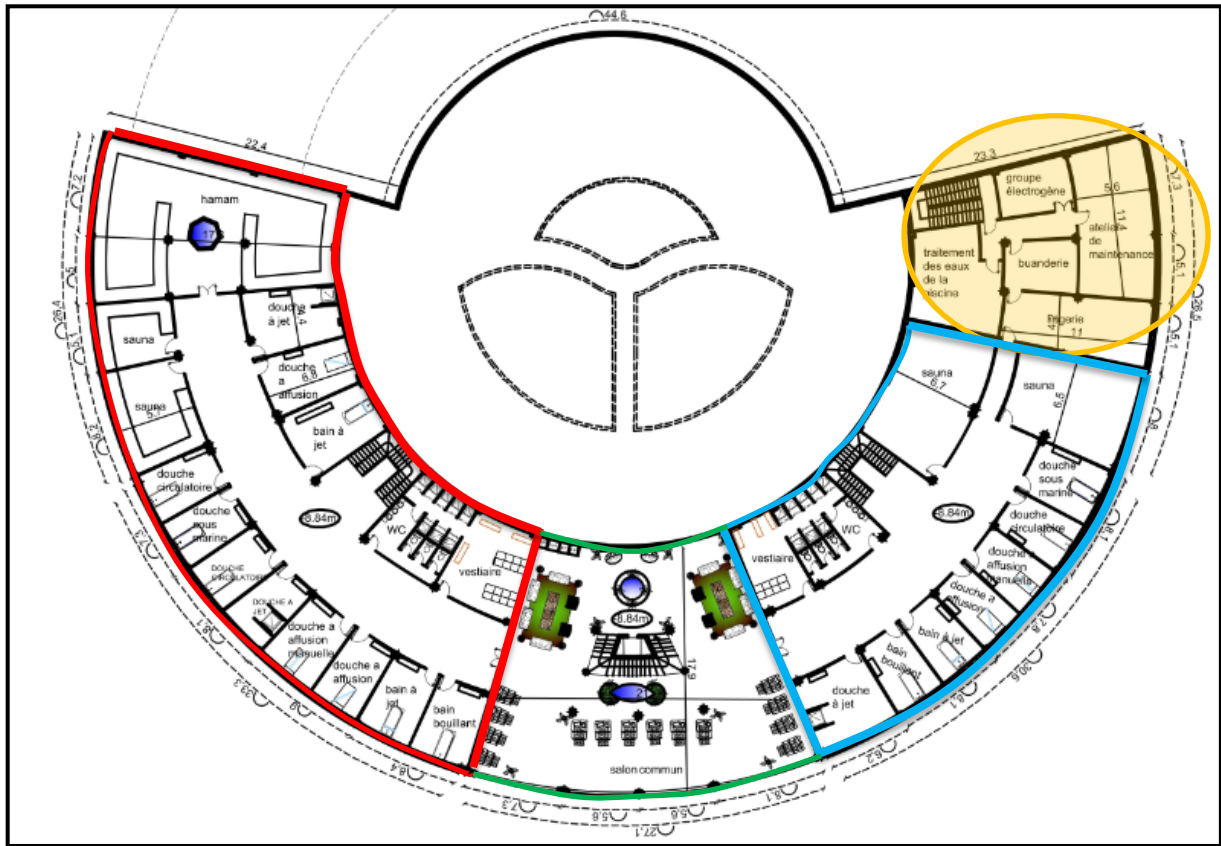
plan de sous-sol niveau -8.00m traité par auteur
